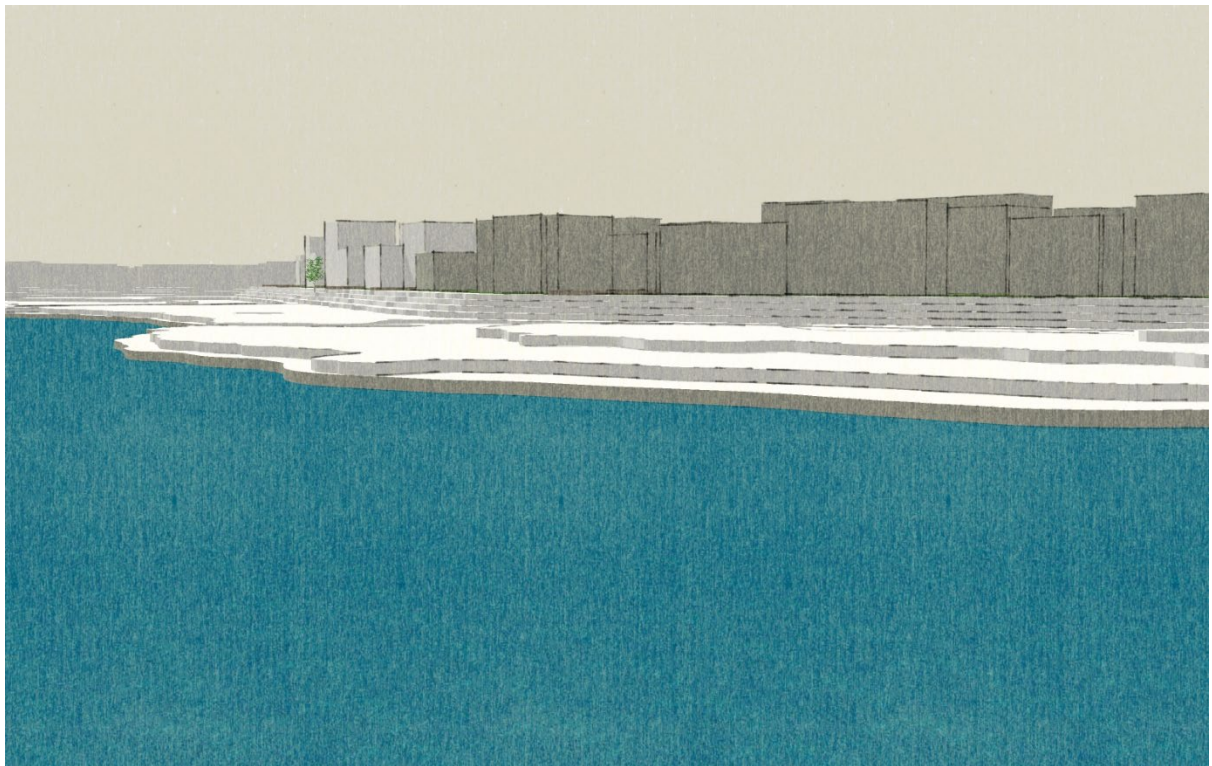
planområdet sett fra regulert plan i Skjærvaveien 44
